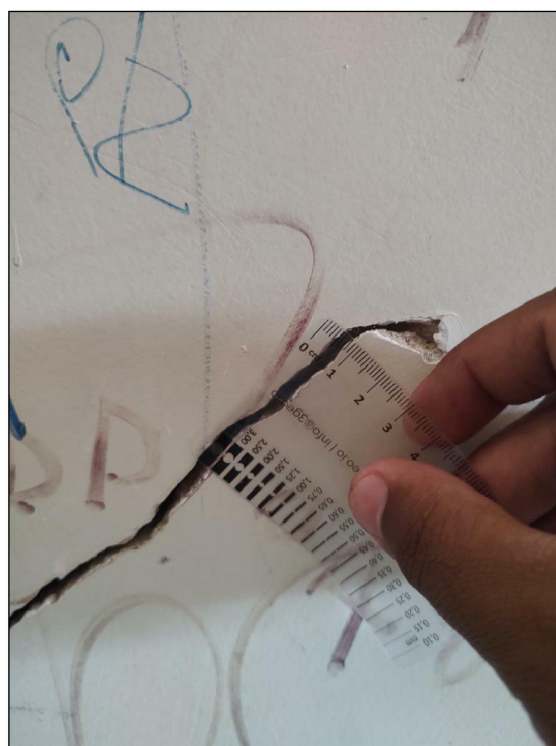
Trinca horizontal (seta amarela) em parede localizada ao lado da caixa de gordura da Foto 16.
